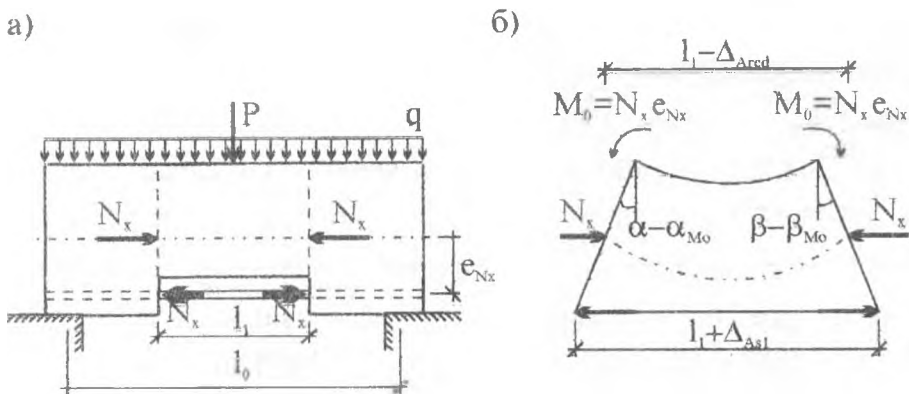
Расчетная схема и схема деформаций изгибаемого элемента с нарушенным сцеплением арматуры с бетоном в пролете:
